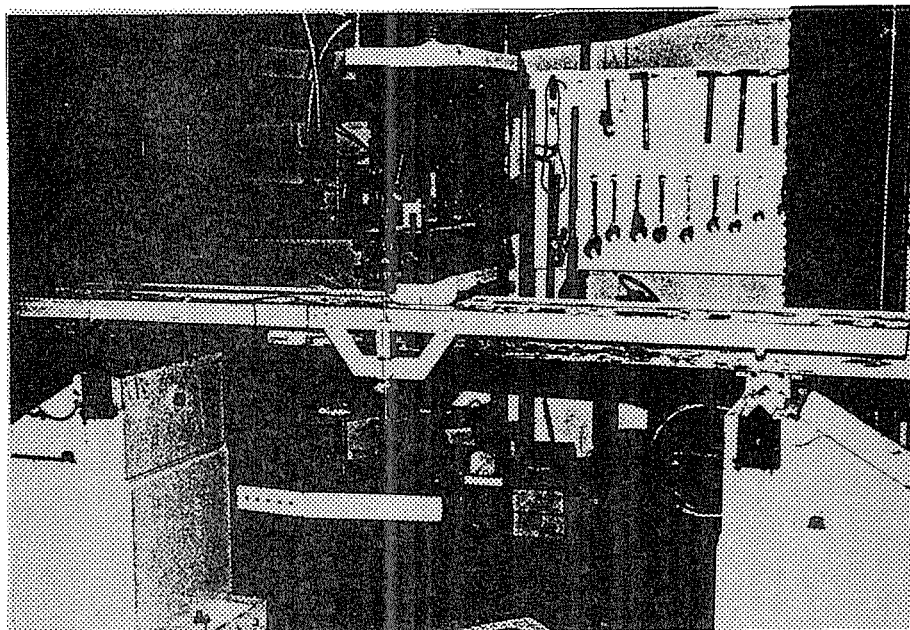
たいこ挽材 flat wise (スパン168cm) 曲げ破壊試験
